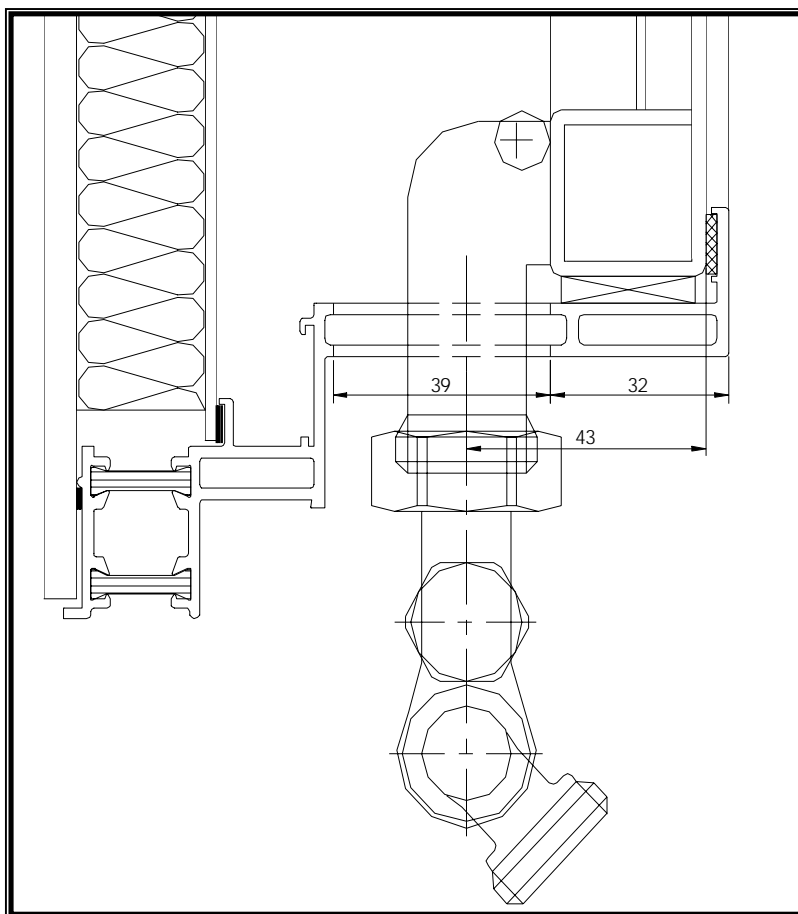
Detail aus Vertikalschnitt mit schwenkbaren Anschluss
